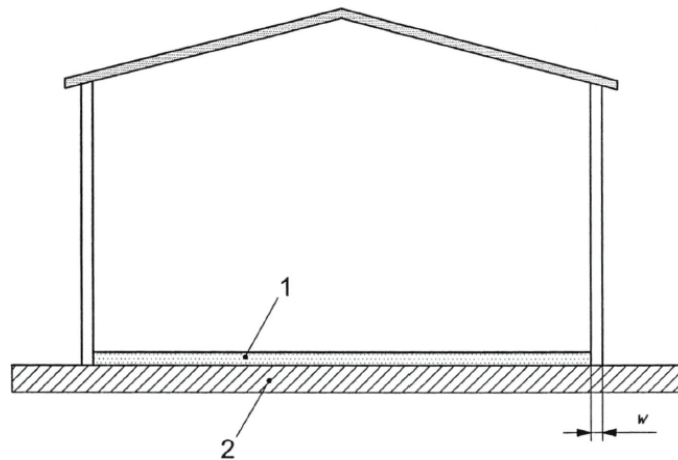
Схема будинку з підлогою першого поверху по ґрунту.
